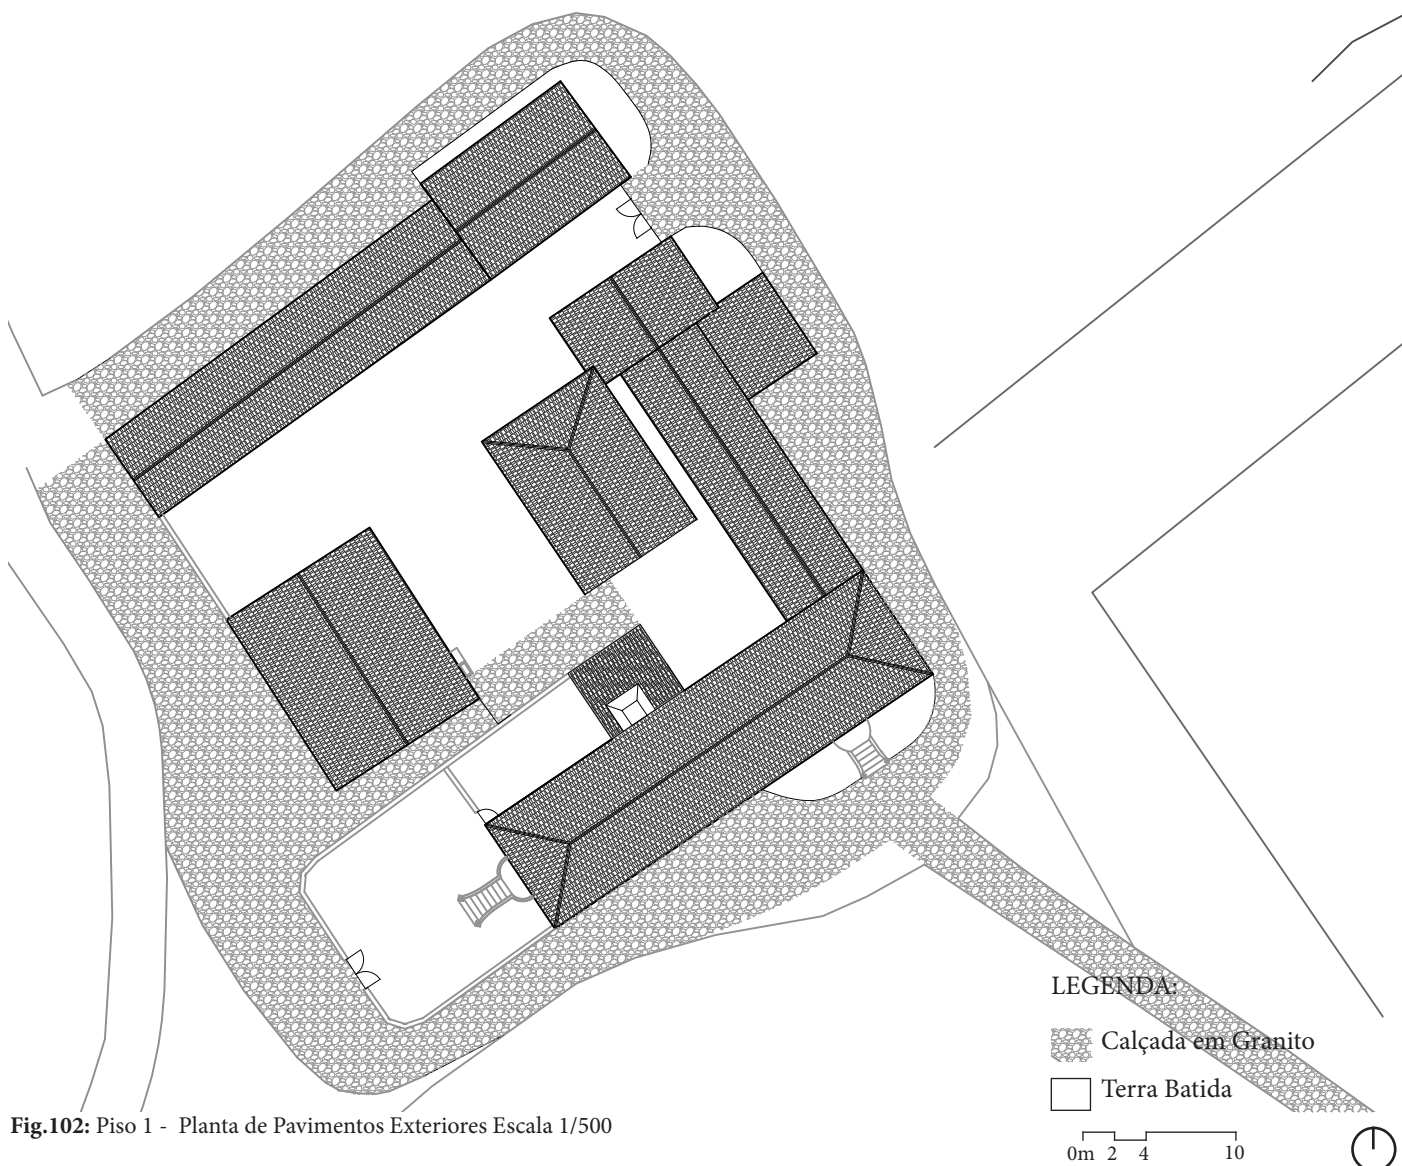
Piso 1 - Planta de Pavimentos Exteriores Escala 1/500
